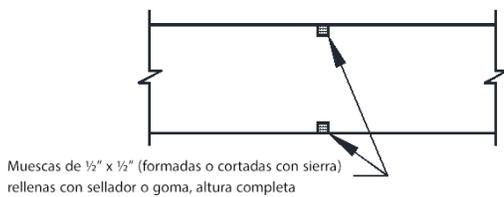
DETALLES DE JUNTAS DE CONTROL PARA CONCRETO
